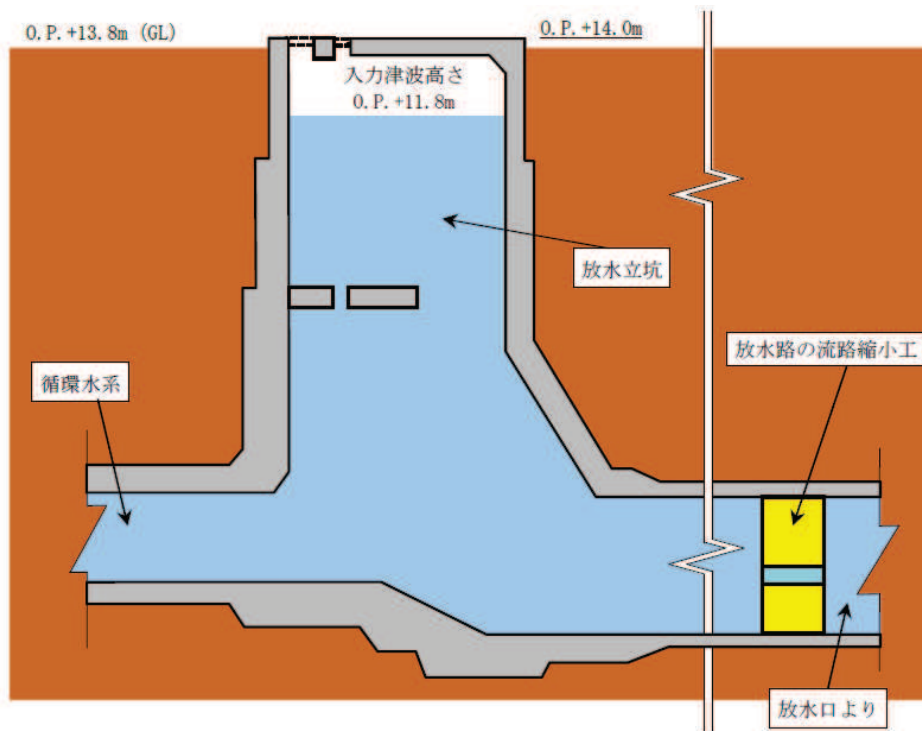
第 1 号機 放水立坑 流入対策配置図 (A-A 断面図)
